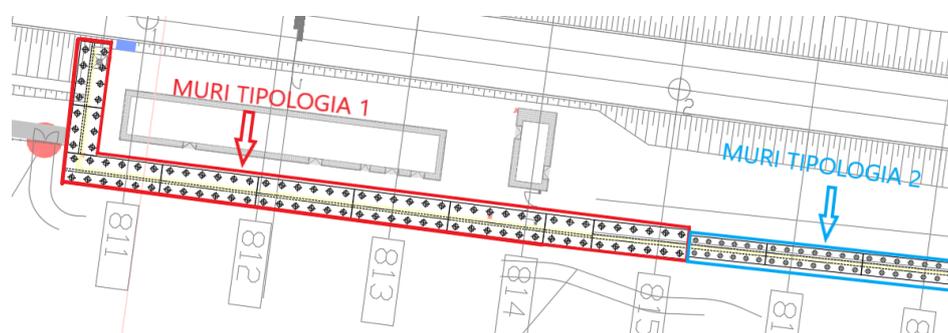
Stralcio planimetrico: ubicazione muri in c.a.
